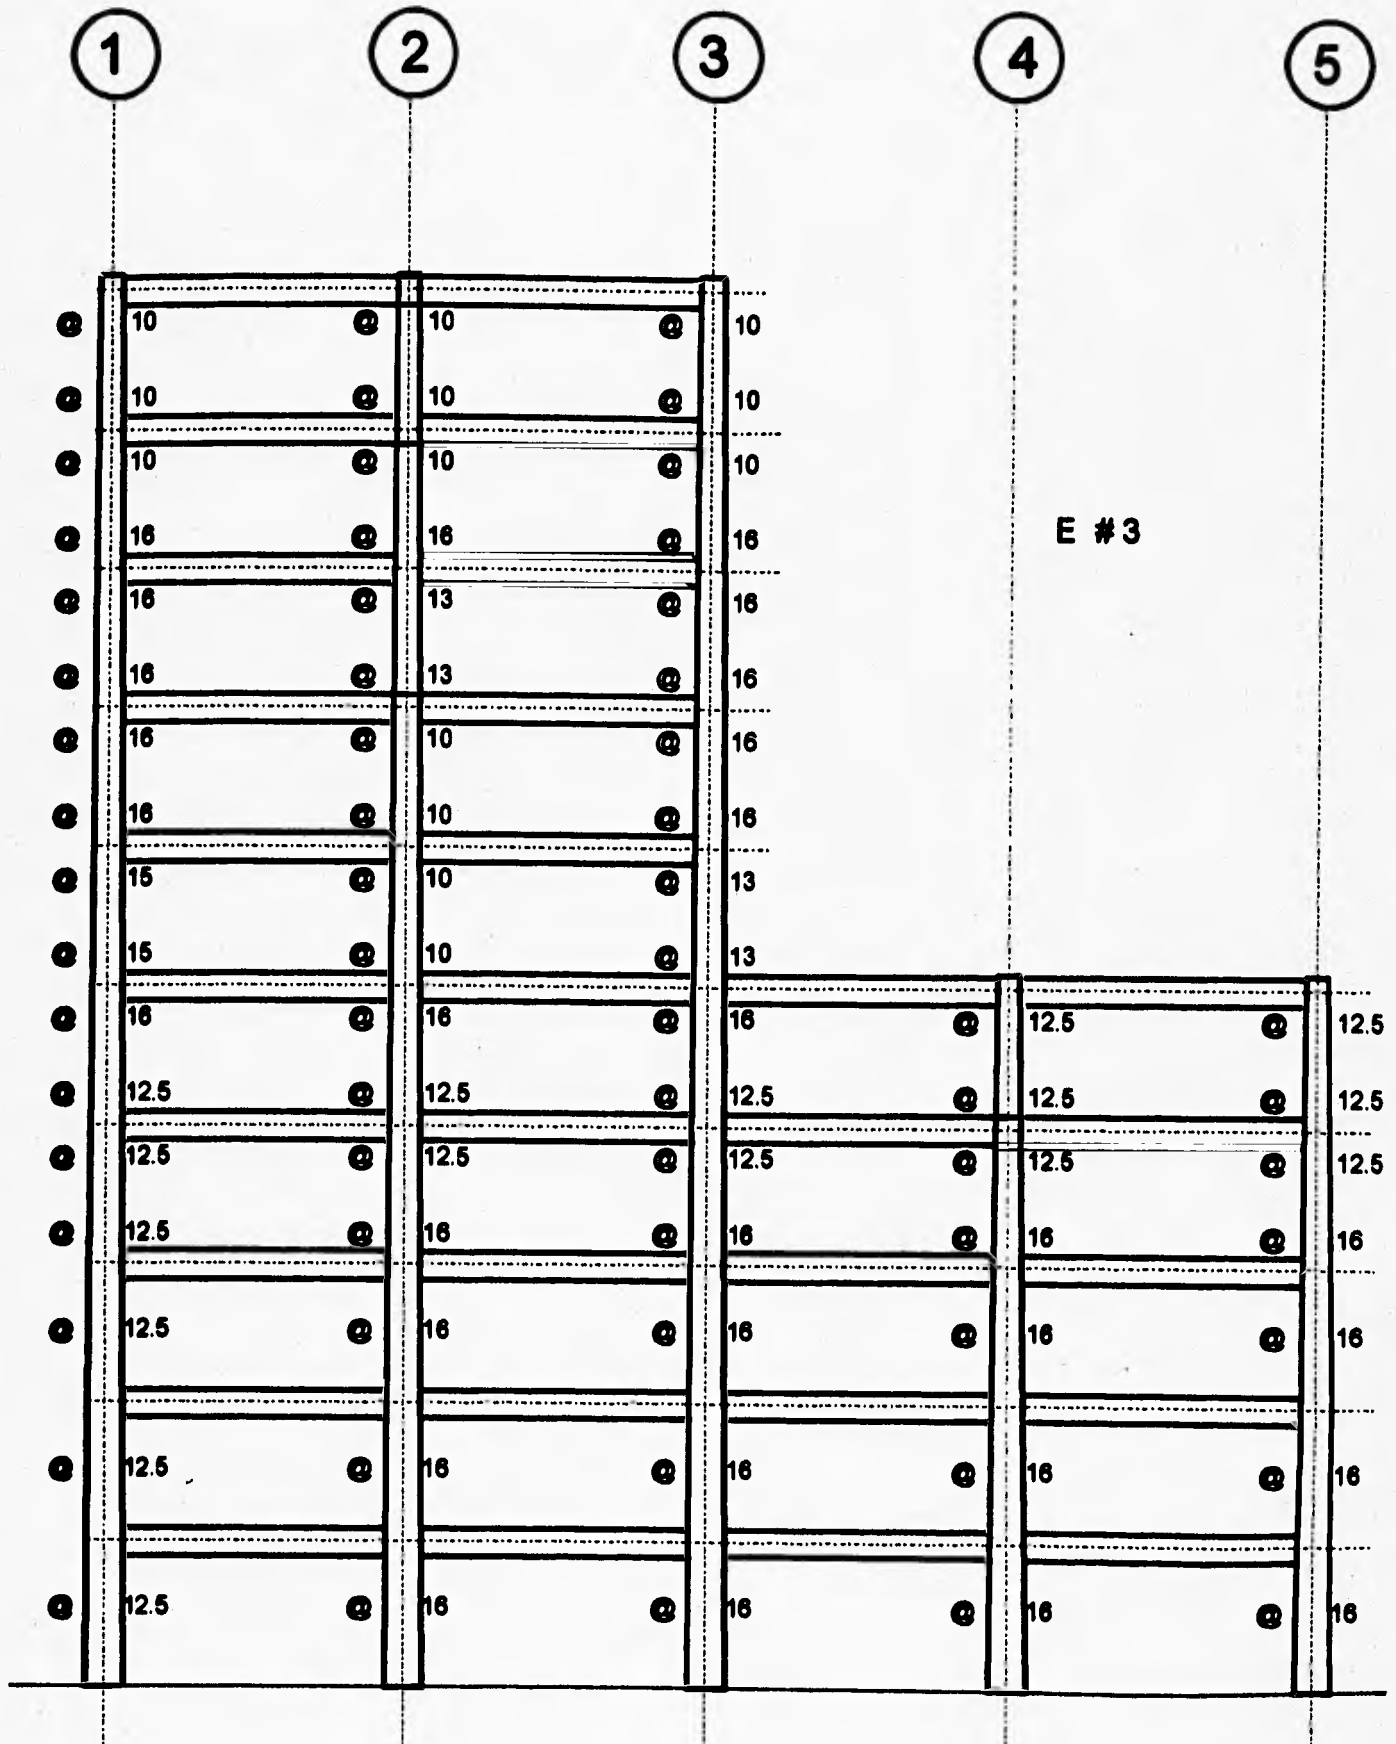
Distribución de Refuerzo Transversal en Zonas Críticas de Columnas, Primer Modelo, $Q = 2.0$
